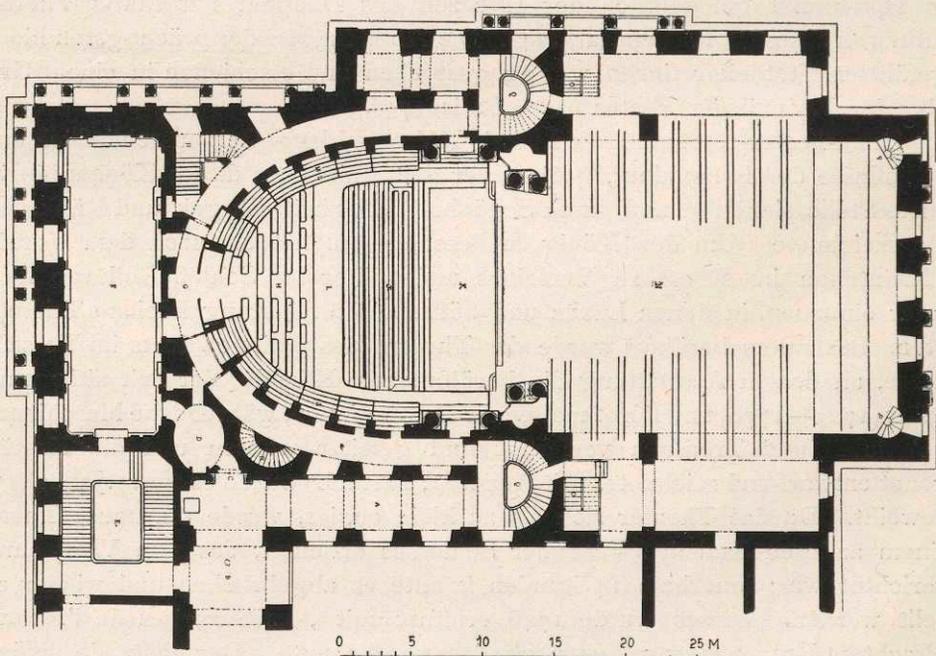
Das Opernhaus zu Versailles: Grundriß.
